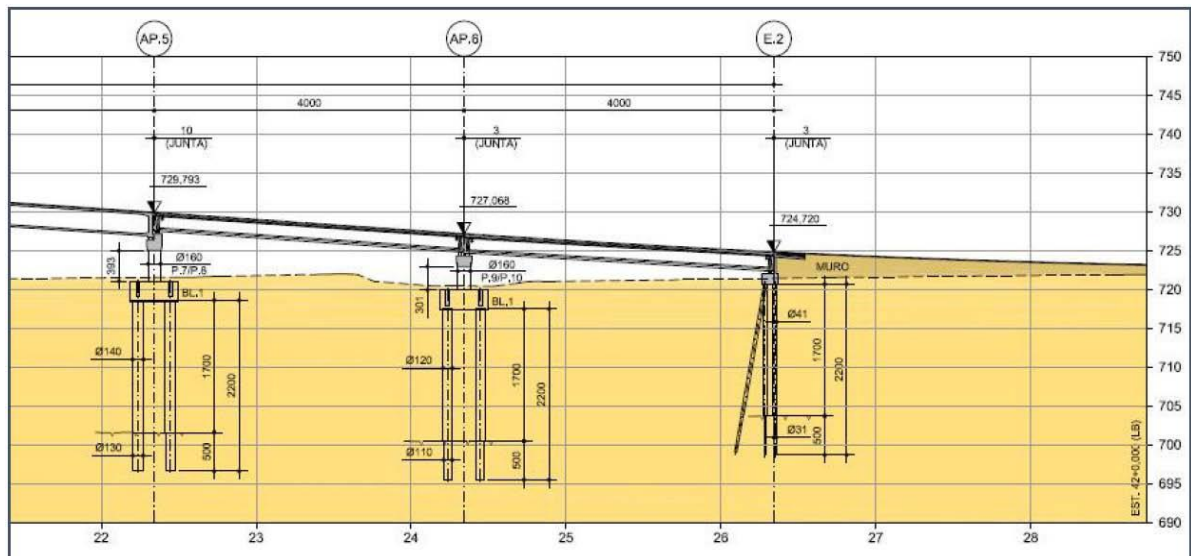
Perfil longitudinal da OAE – pista esquerda 4/4.
